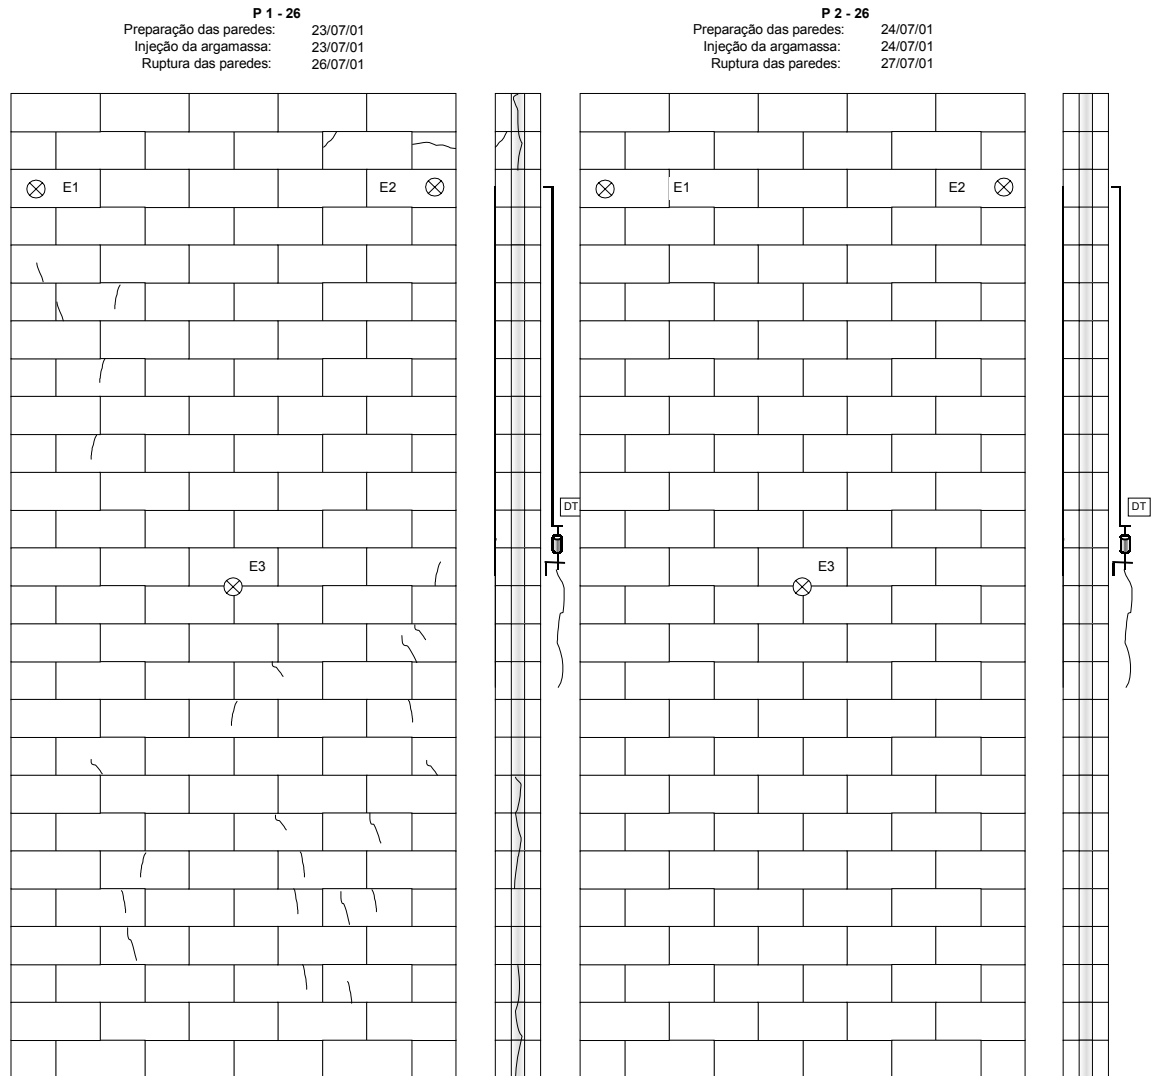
Mapa de fissuração das paredes com 26 fiadas – P1 e P2 - não se conseguiu registrar as fissuras da parede P2
